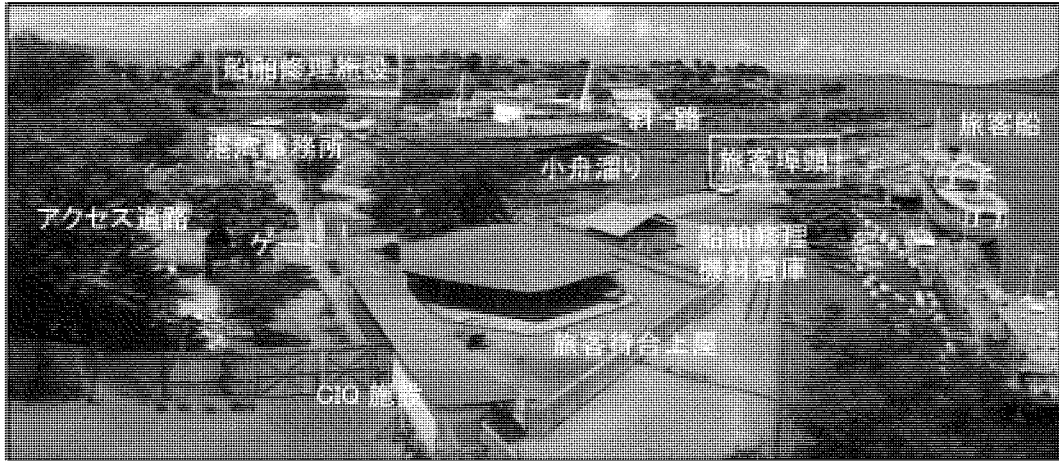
キゴマ港旅客埠頭の施設配置図
